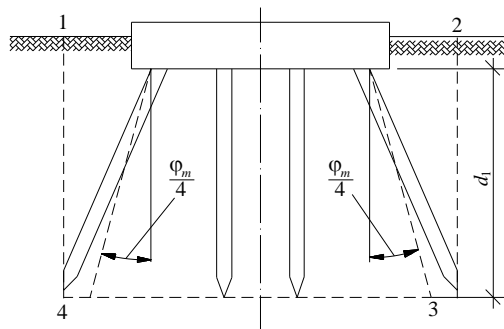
Условный свайный фундамент с ростверком, заглубленным в грунт, при угле наклона свай более $\varphi_m/4$
